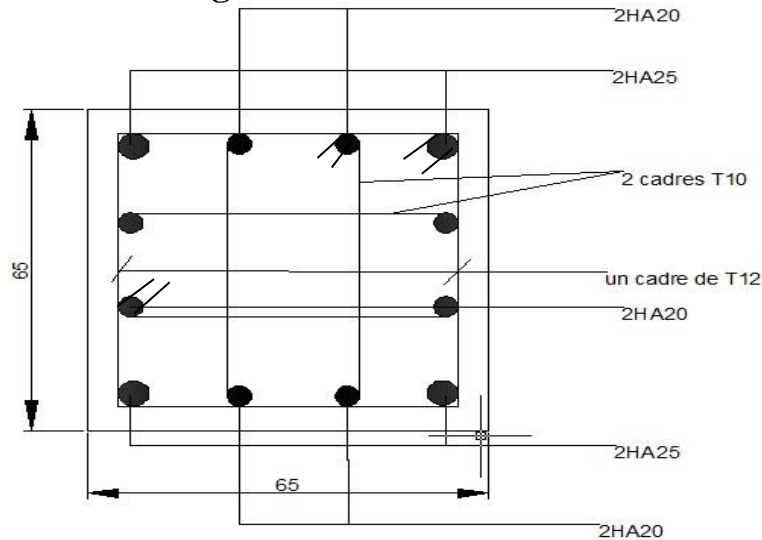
croquis de ferrailage de poteau 65x65cm² de zone 1
